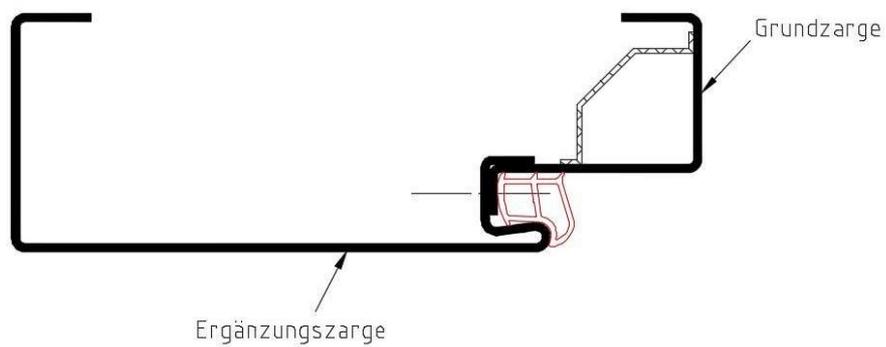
Zargenprofil – 2-schalige Stahlzarge
